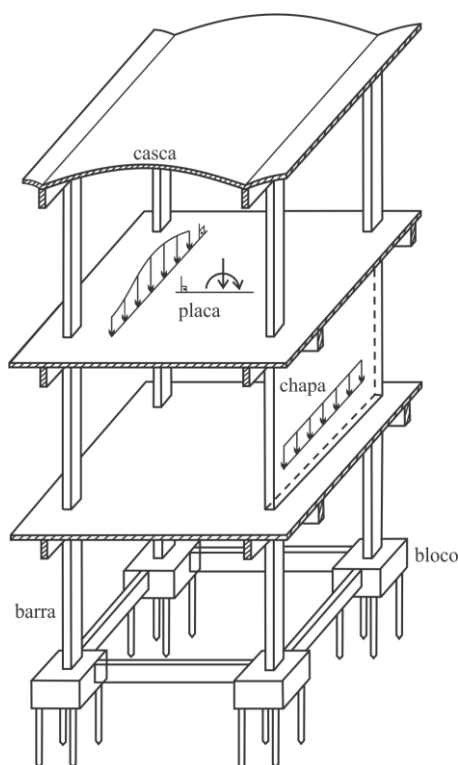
Elementos estruturais: placa (a); chapa (b).
